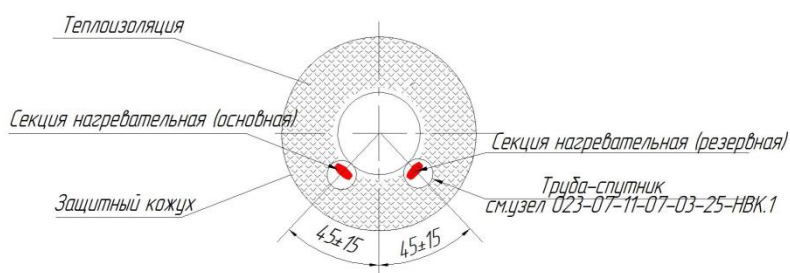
Схема монтажа греющего многожильного саморегулирующегося кабеля Drexan HeatTracer на систему водоснабжения
